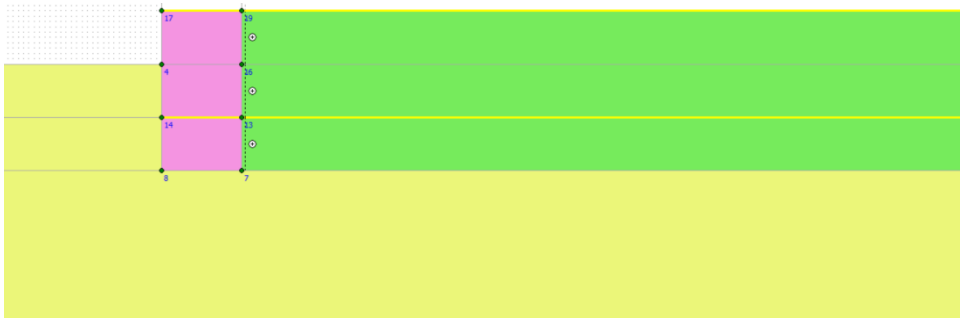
Mise en place d'une couche de remblai et Installation de la première
